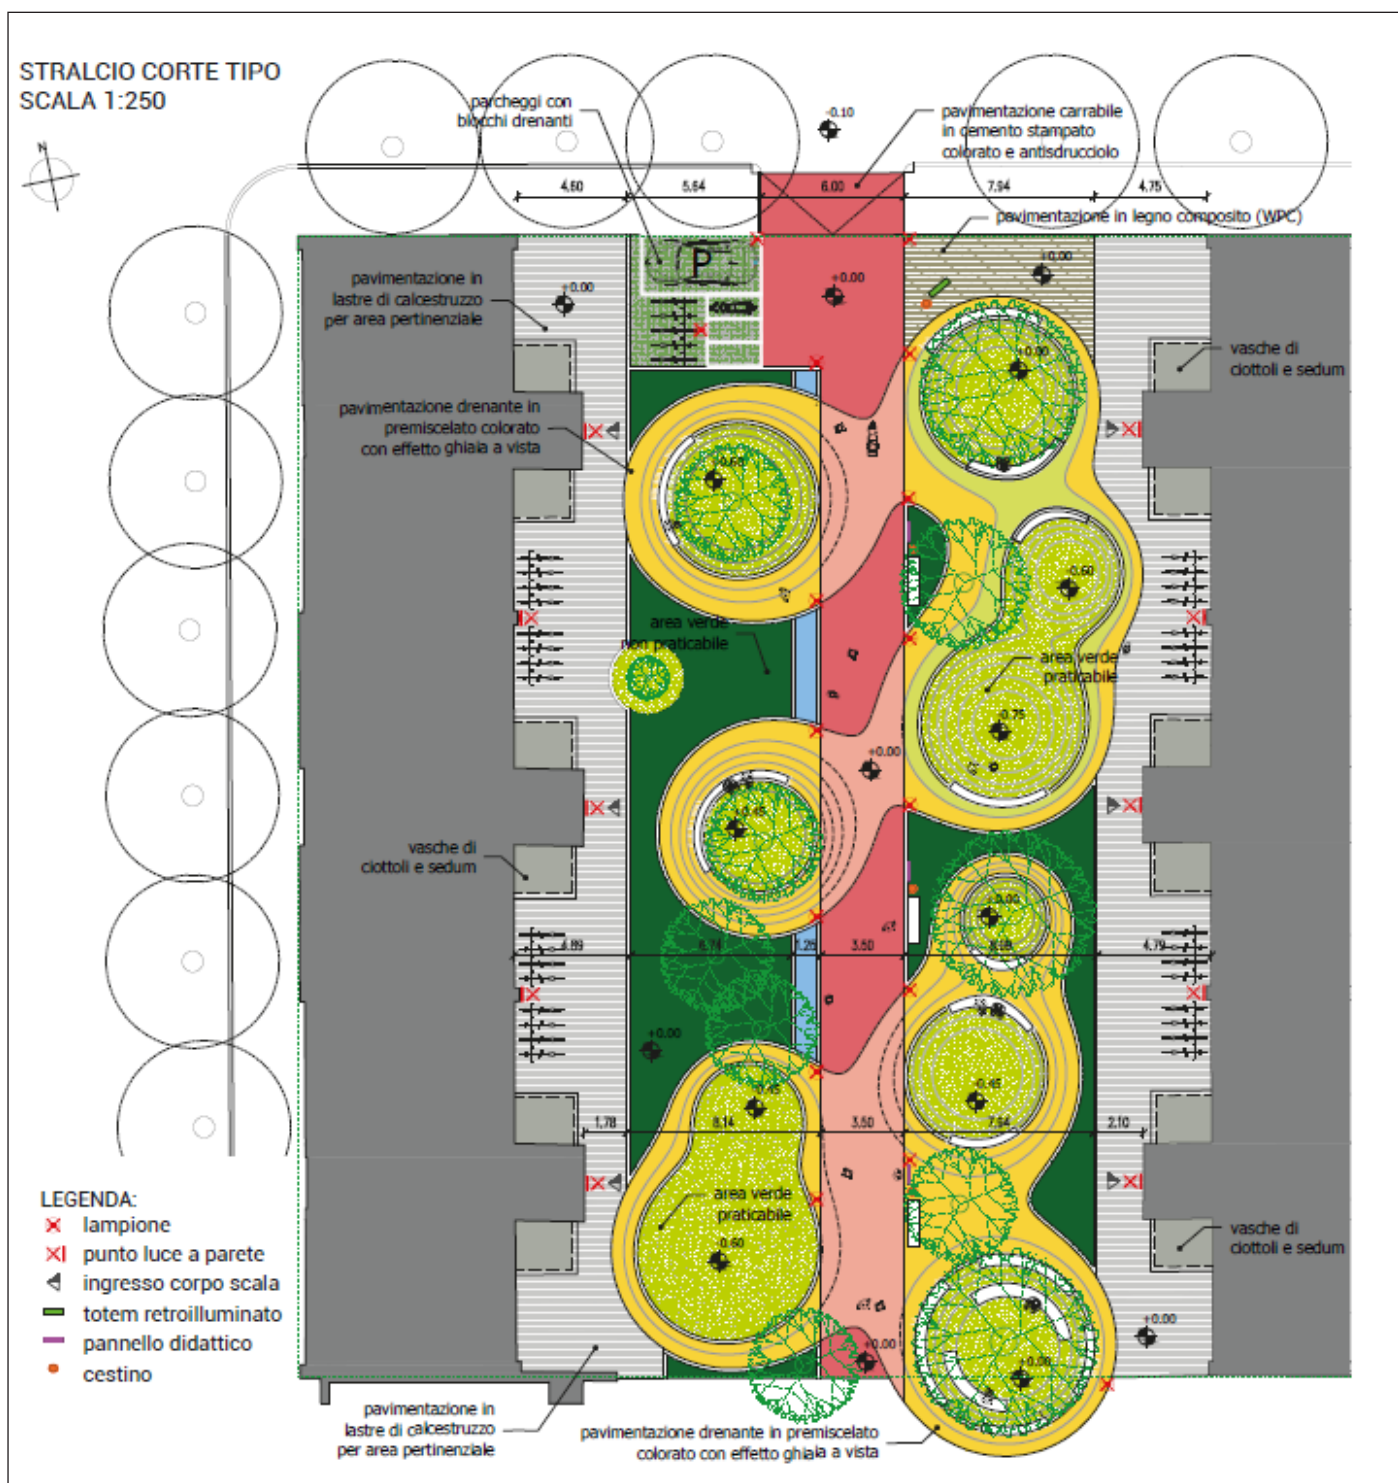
PLANIMETRIA DI PROGETTO "IL PARCO DELLA RESILIENZA" - STRALCIO CORTE TIPO (per gentile concessione di Giulia Pentella, SUMs architects)
